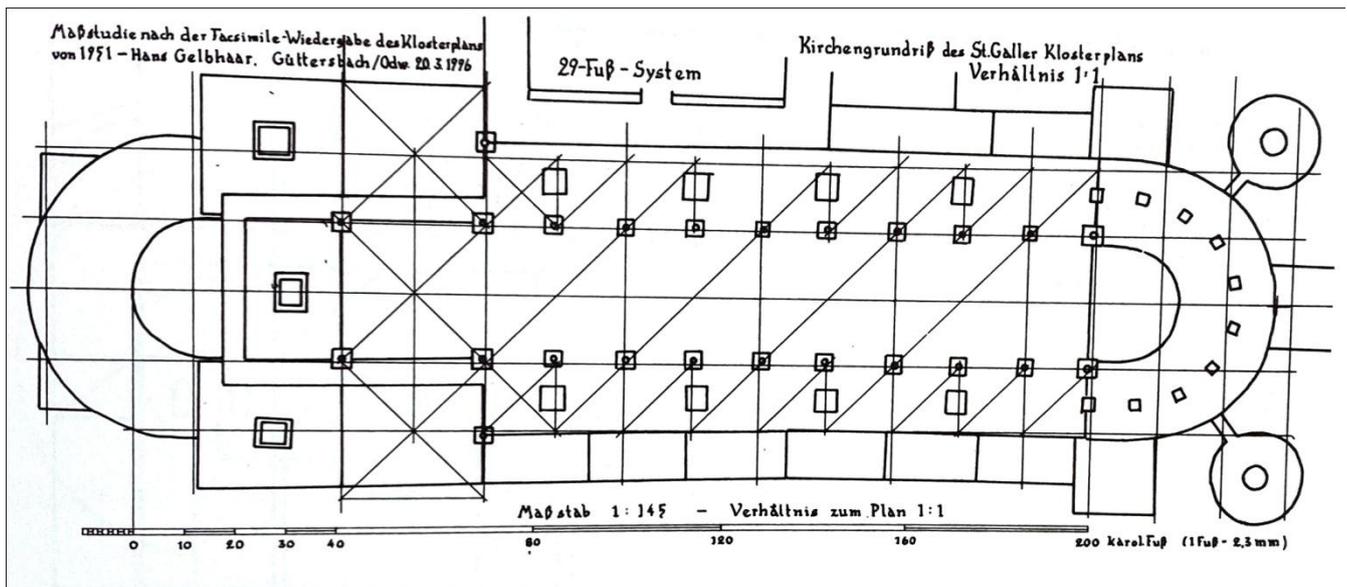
Hans Gelbhaar, Kirchengrundriß mit 29 Fuß- Schema.
